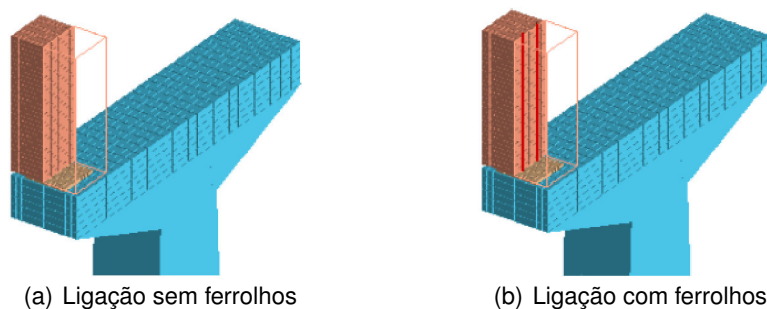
Modelação do processo construtivo da ligação viga-pilar.
